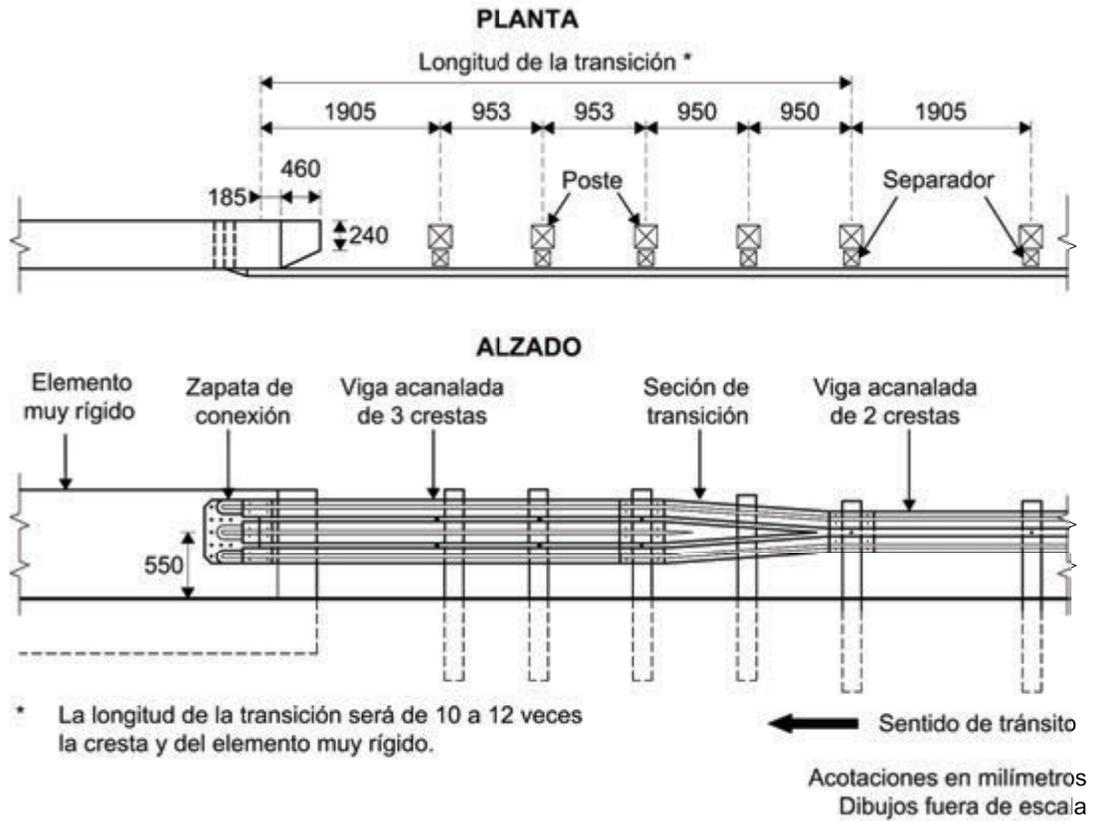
Transición de barrera metálica de dos a tres crestas y a muro vertical recto
